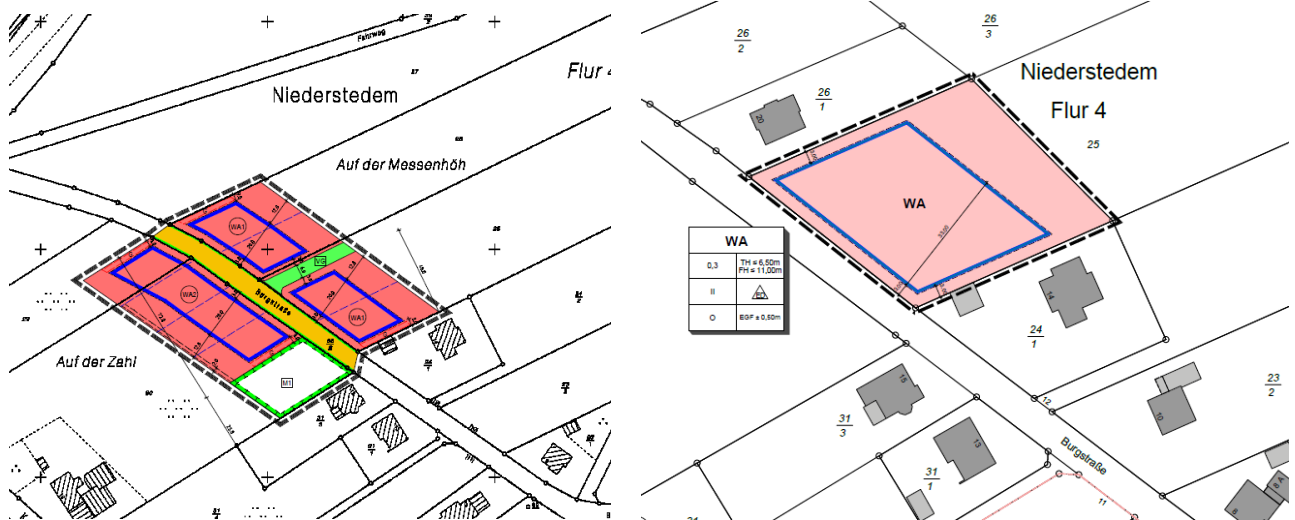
Bebauungsplan „Auf der Messenhöh“, Ursprungsplan (links) und 1. Änderung (rechts – Quelle ISU, jeweils ohne Maßstab)
